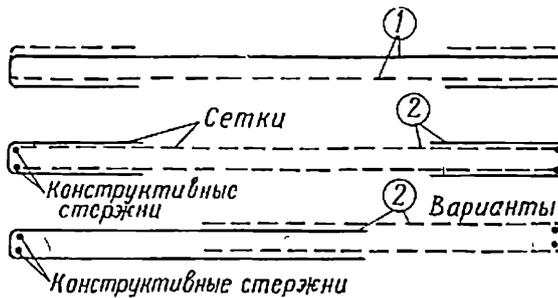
2. Армирование непосредственно опертю и загруженной поверху балки-стенки
